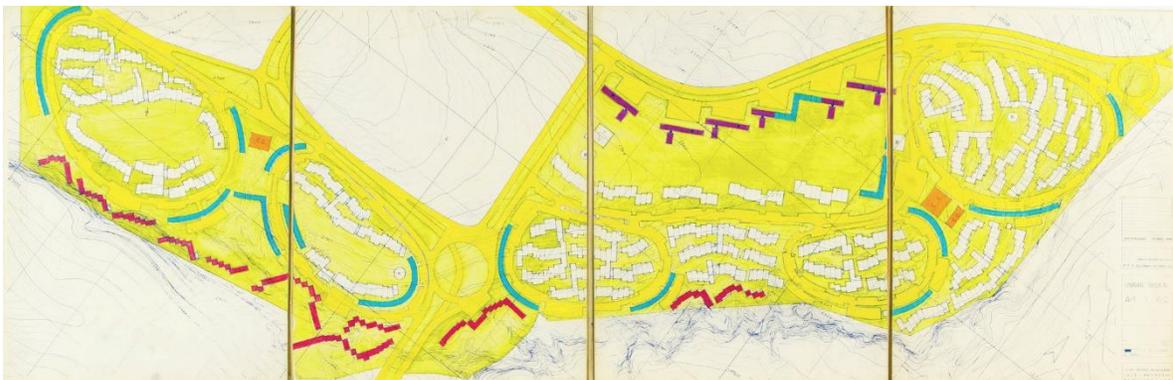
Planta Unidad Vecinal A1 y A2 del Plan Maestro preliminar de Lomas Verdes, del 30 de abril de 1965. Fuente: Fundación Barragán.
